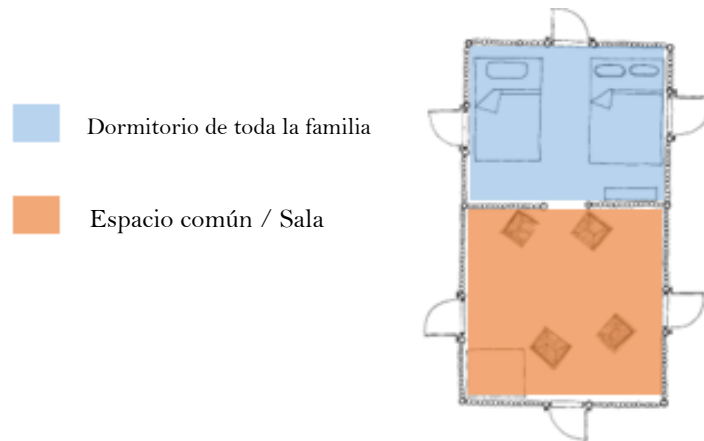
Planta típica de bohío de un aposento, donde la ubicación y el número de huecos varía por región.
